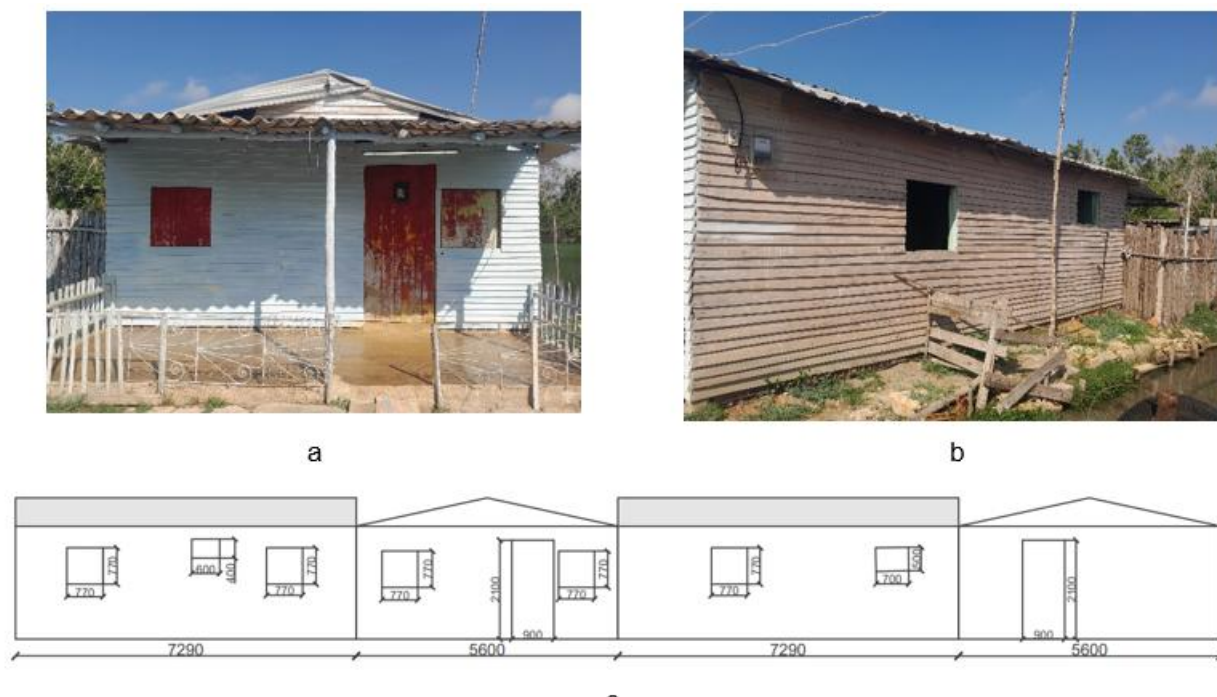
Fotos de la vivienda objeto de estudio. a) Imagen frontal, b) Imagen del lateral. c) Vista desplegada (unidades en mm) Fuente- (Elaboración propia).
